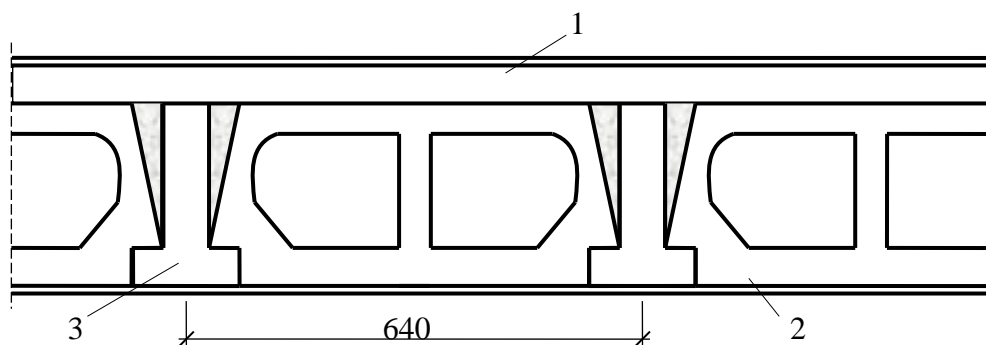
Схема збірного часторебристого перекриття з верхньою монолітною плитою:
